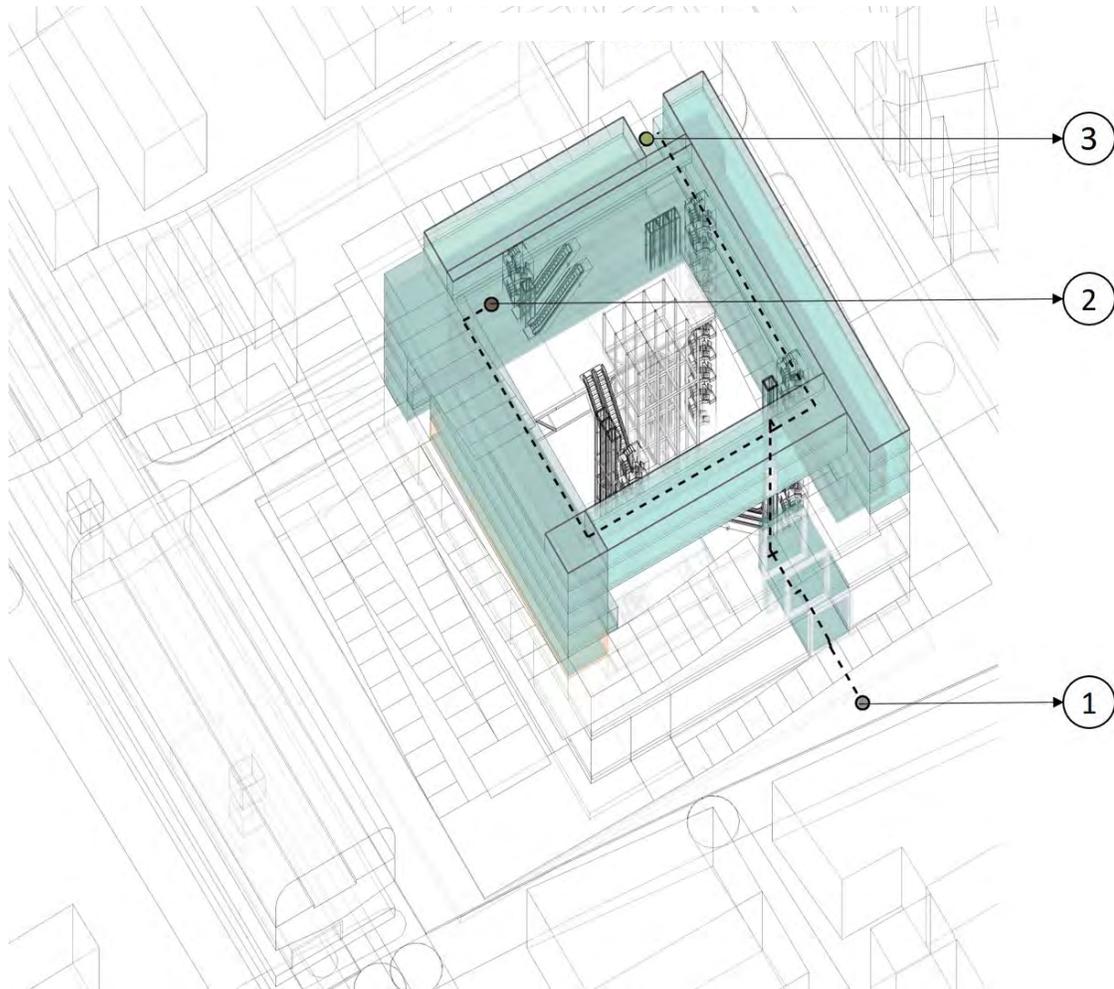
La promenade en el estrato vivienda-comercio. 1 corresponde al acceso desde la planta baja. 2 corresponde a la posibilidad de pasar al mercado y 3 a la posibilidad de pasar al estrto parque.
